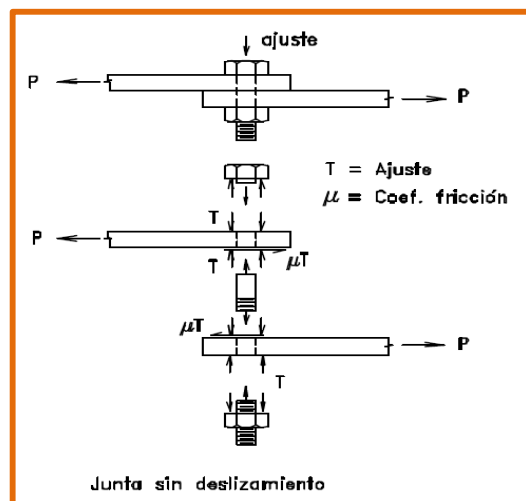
JUNTA SIN DESLIZAMIENTO
